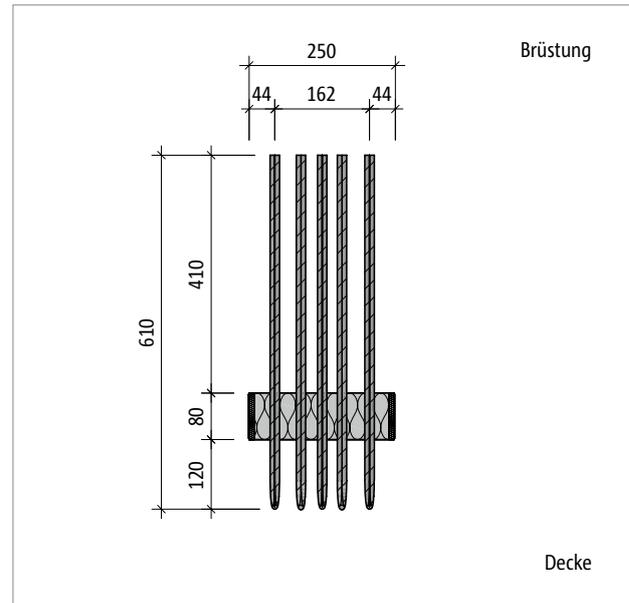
Schöck Isokorb® T Typ AP: Produktansicht
